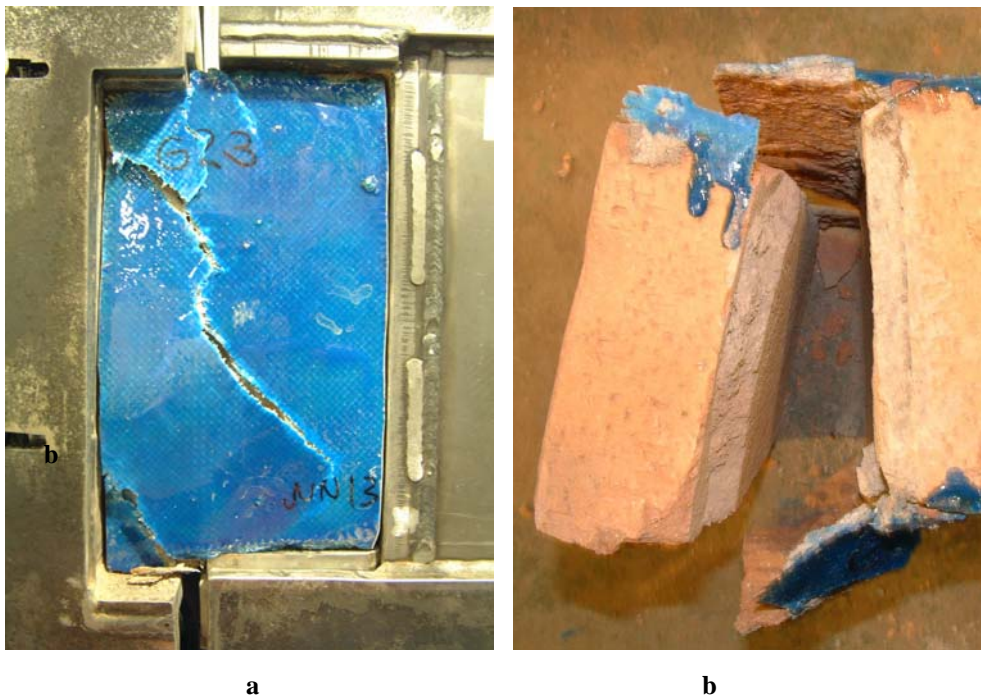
Modo de fallo del conjunto *Ge*: (a) fisura de la capa de tejido (b) detalle de la probeta ensayada en donde se observa la capa superficial de la probeta adherida al tejido de refuerzo.
